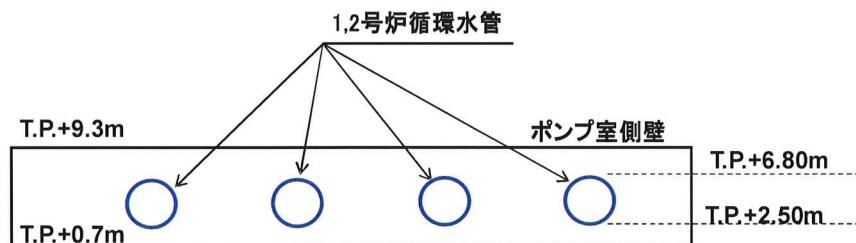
1, 2号炉循環水管埋設部⑤断面図
